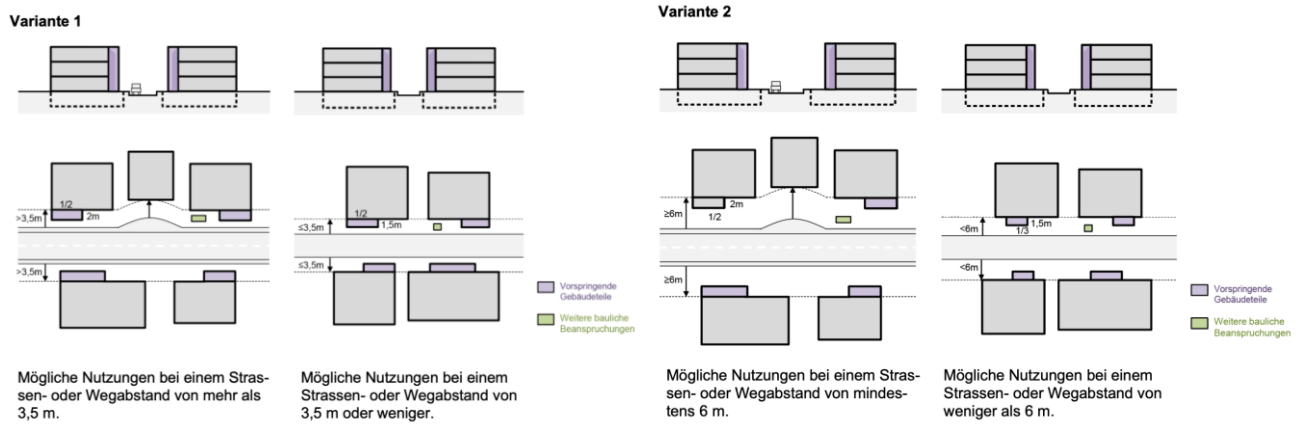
Gegenüberstellung Variante 1 und 2 zur Regelung der zulässigen Masse (Quelle: Vorentwurf PBG-Revision «Baulinien» mit erläuterndem Bericht vom November 2023)
